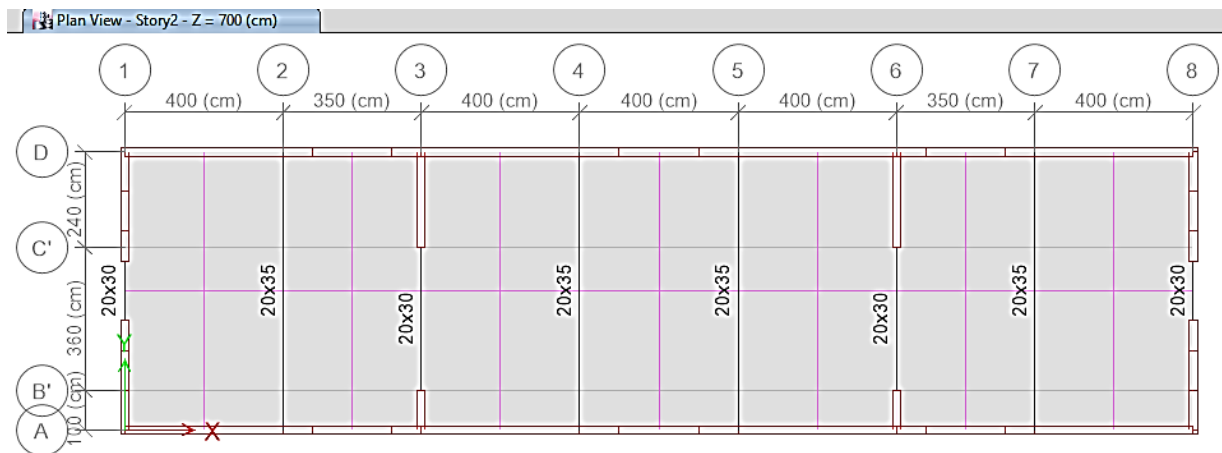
Vista de Planta del Nivel 2 del Edificio
